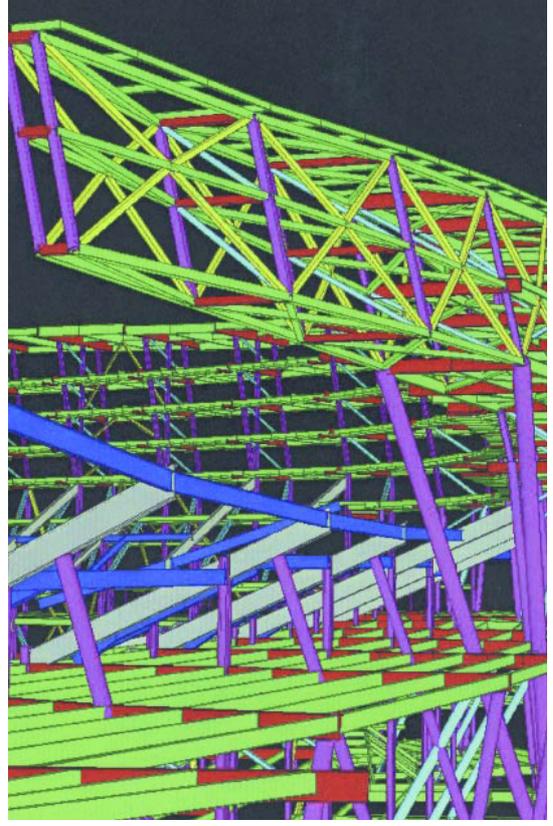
솔저 필드 경기장 철골 구조물의 3차원 모델 (출처: Modern Steel Construction, July 2004)
